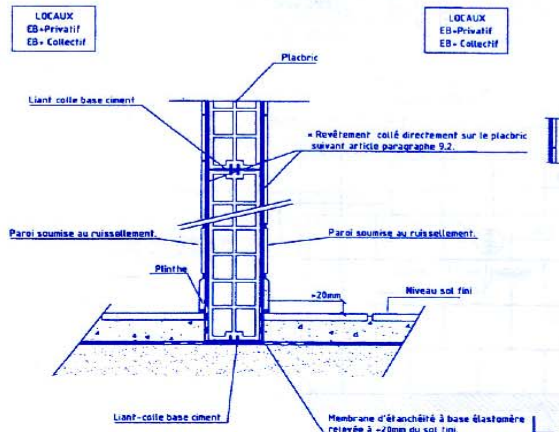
b – Pied PLACBRIC séparant locaux EB + privatif / EB + collectif (carrelage) de locaux EB + privatif / EB + collectif (carrelage) avec parois soumises au ruissellement
